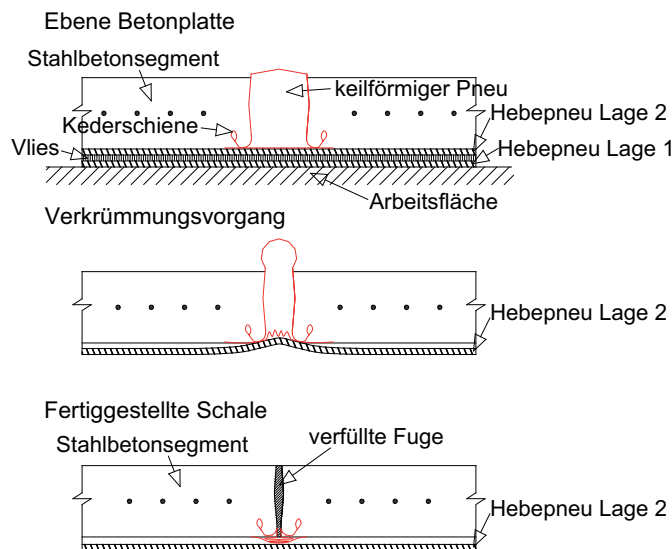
Schnitt durch Pneu und Stahlbetonsegmente
